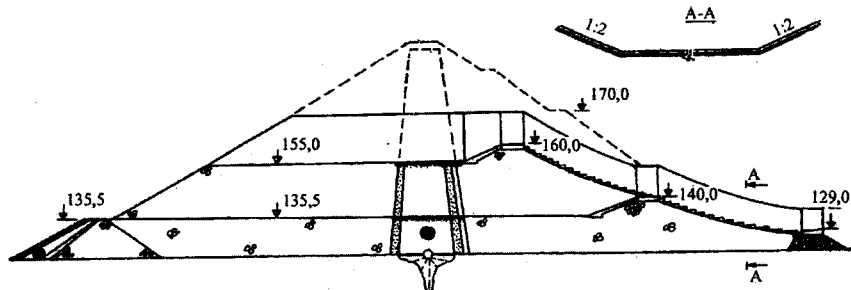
Вариант конструкции водосброса грунтовой плотины Курейской ГЭС с креплением сборными железобетонными плитами типа «чешуи»
